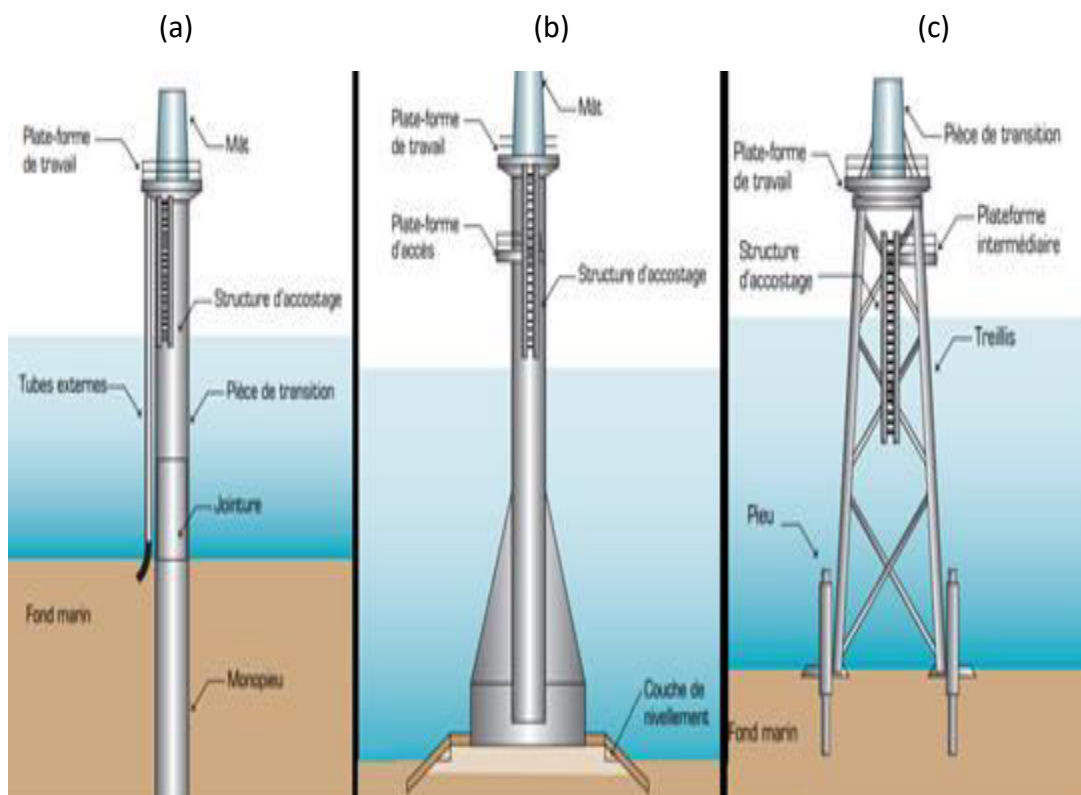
Type Fondation offshore : a) la fondation monopieu
